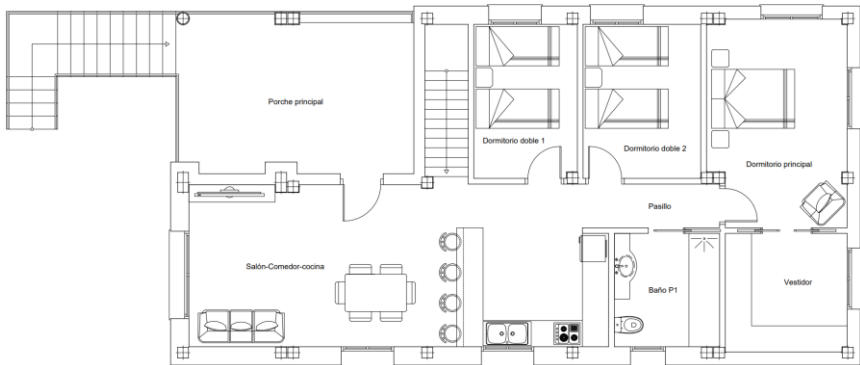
Distribución planta primera reformada. 2024. Fuente: Propia
